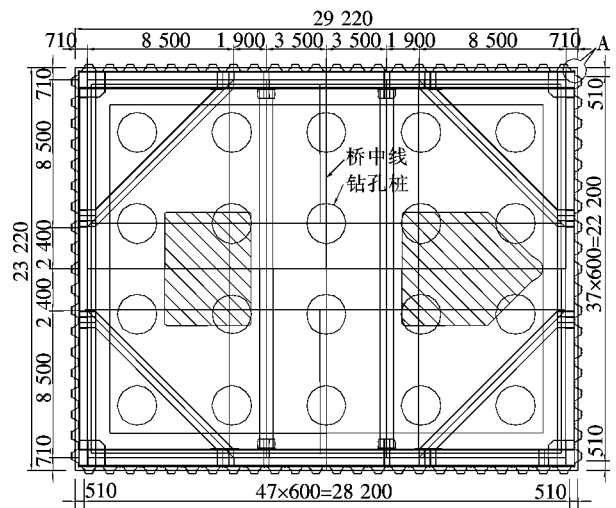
水下封底导管区域划分及平面图布置(单位:mm)
